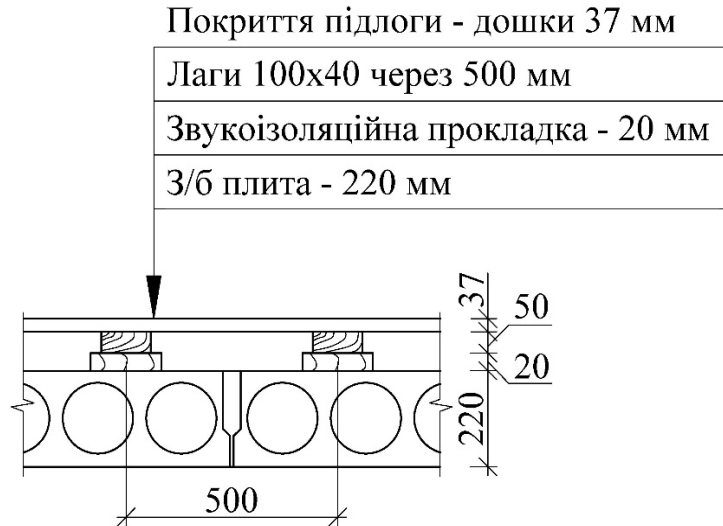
Поперечний переріз перекриття між першим та другим поверхом будівлі школи
